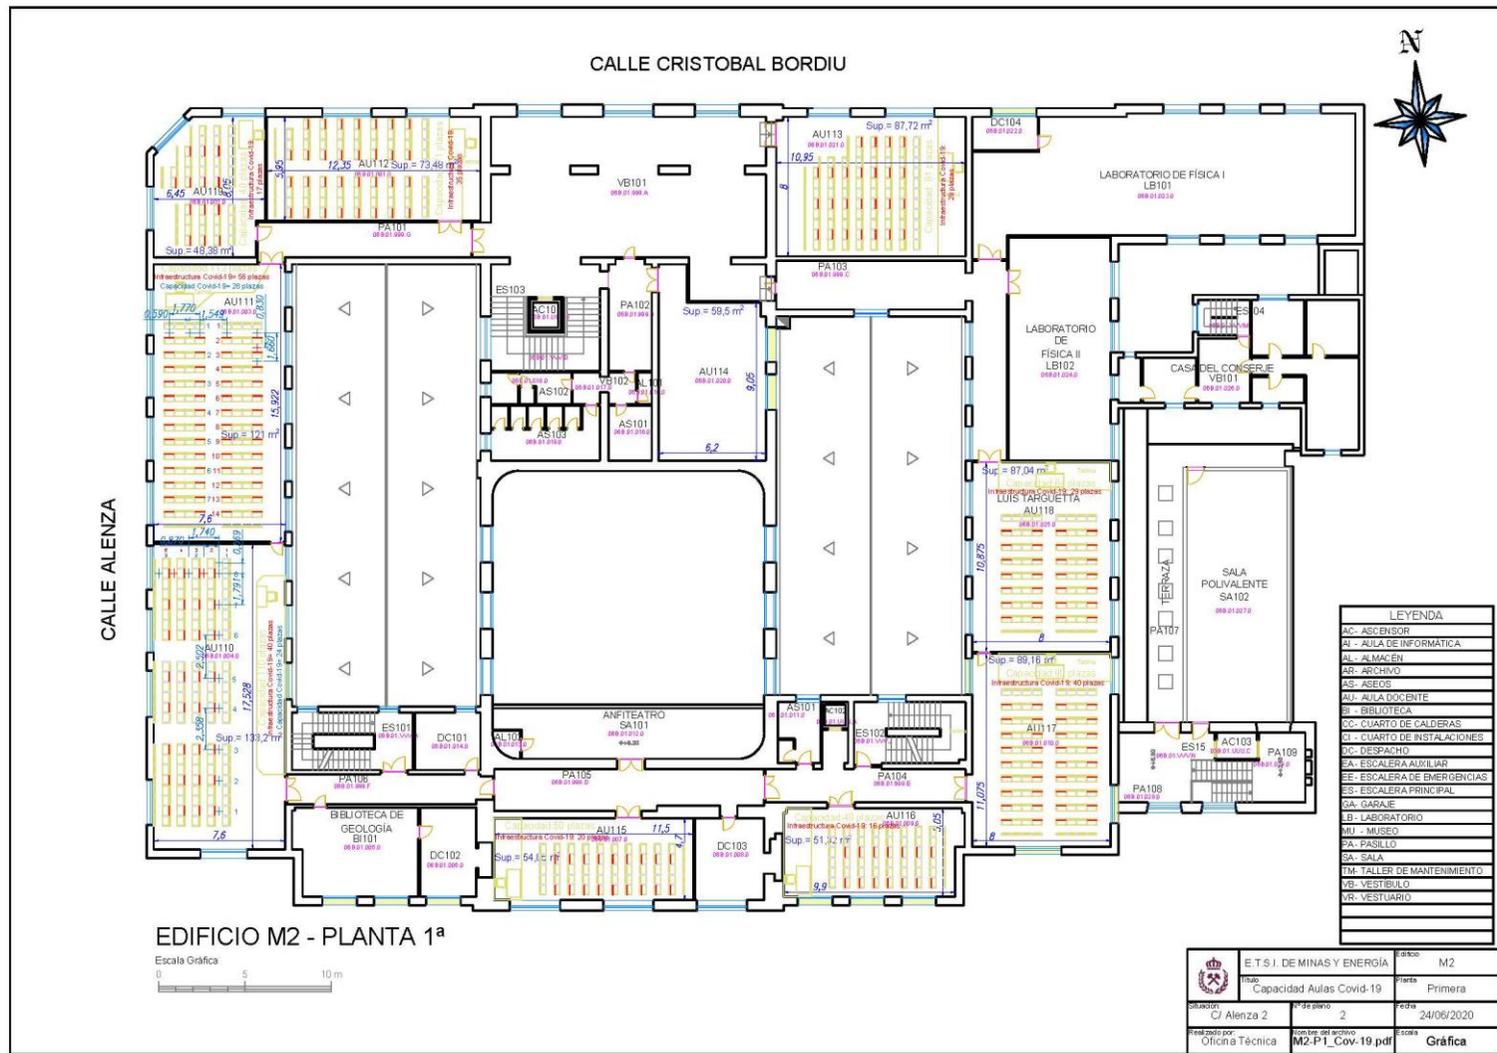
Ubicación de las mamparas de protección en las aulas del M2 planta 1
